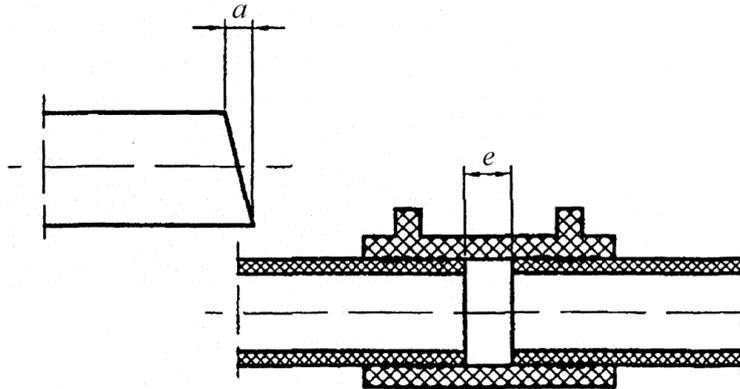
Схема соединения труб муфтой с закладными нагревателями
